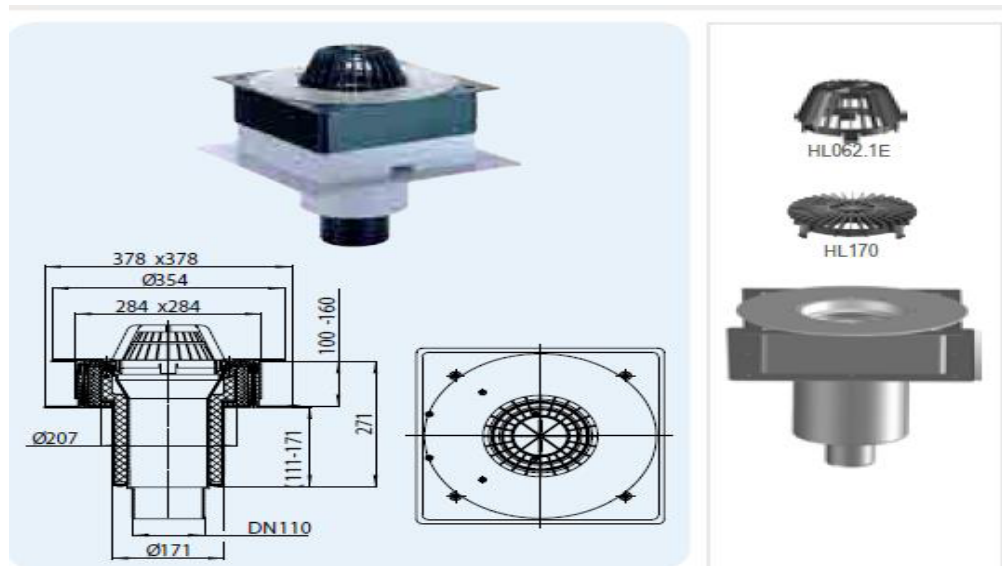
Загальний вигляд та креслення з розмірами воронки HL63P\1
